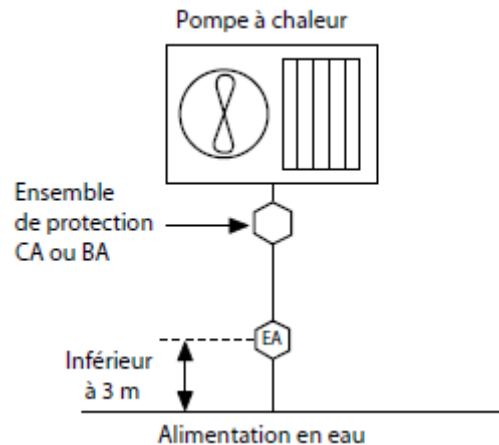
un clapet de non-retour est à prévoir systématiquement à moins de 3 m du piquage sur l'alimentation en eau
